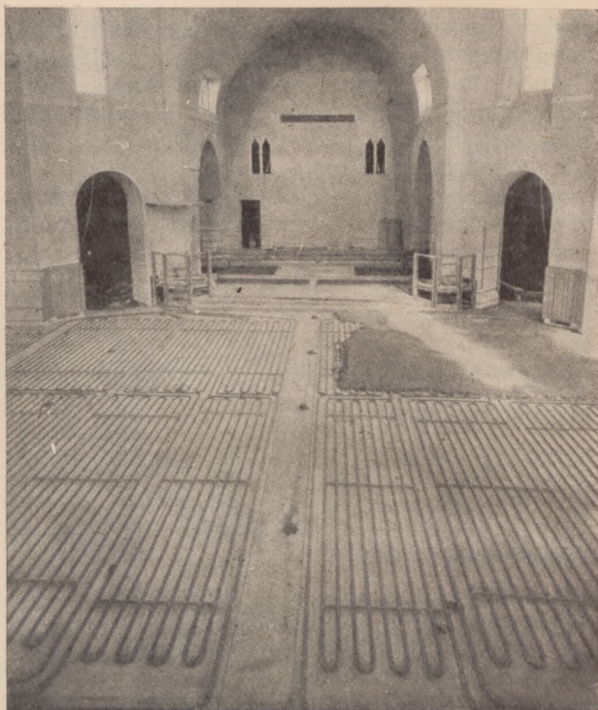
Widok całości instalacji. W głębi na prawo — pokrywanie rur betonem; beton powinien być — o ile można — jak najmniej wilgotny.
